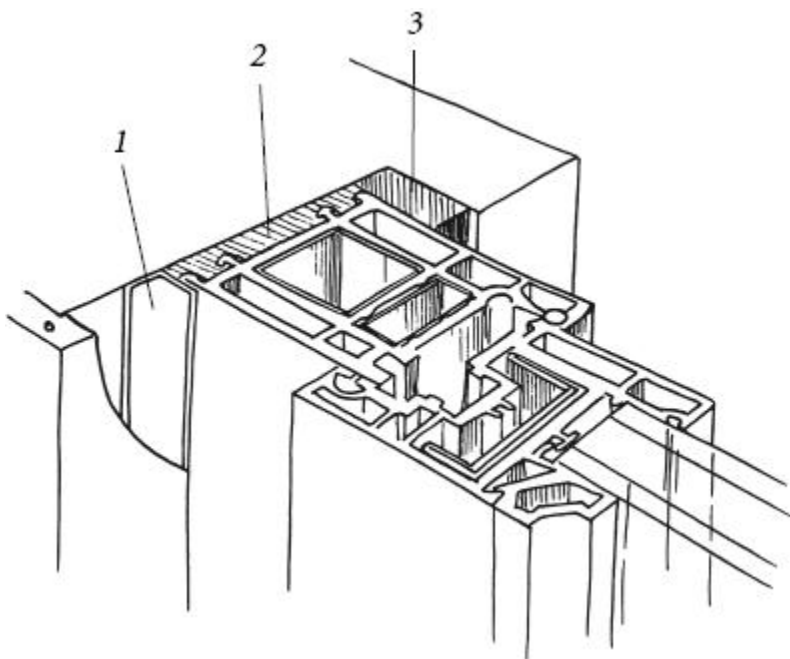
Изоляция оконного проема гидроизоляционной лентой: 1) теплогидроизоляционная лента; 2) монтажная пена; 3) паропроницаемая гидроизоляция
